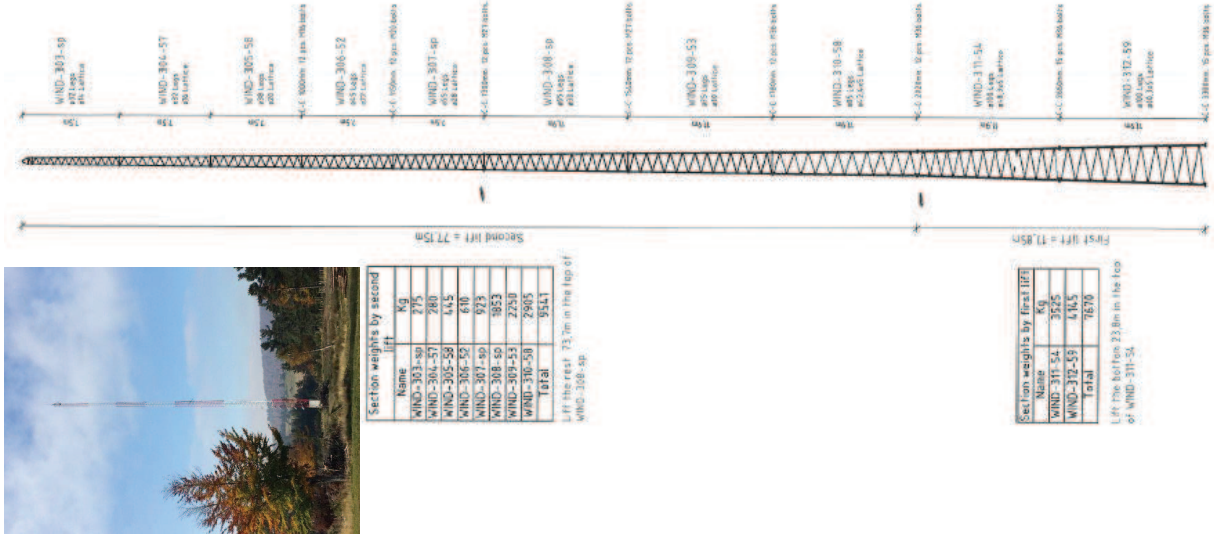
Plan d'élevation mât de mesures météo permanent (Source : EDPR)
